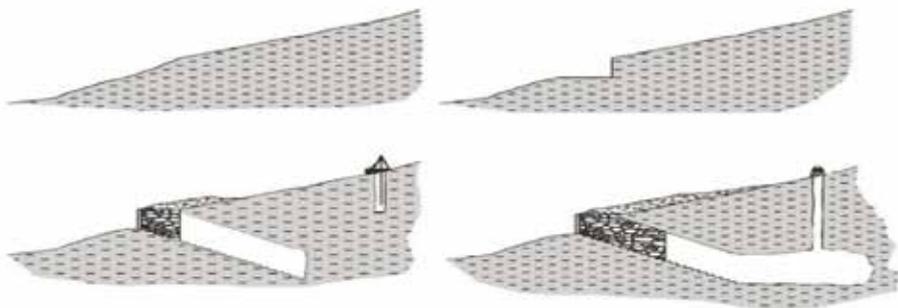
Proceso constructivo de una bodega. Fuente: Cárdenas et al. (2008).
